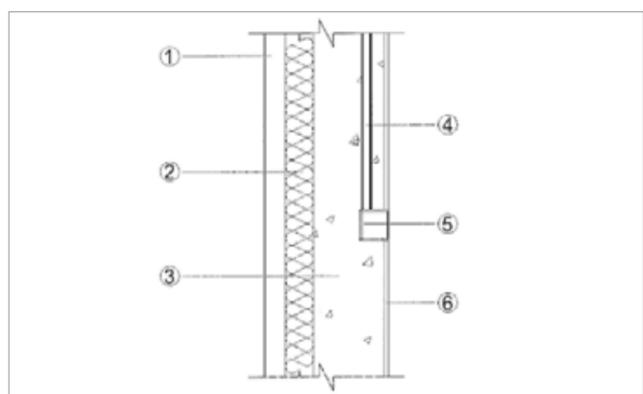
Piso sistema constructivo mediante elementos de hormigón prefabricado (Patentscope, 2018).
